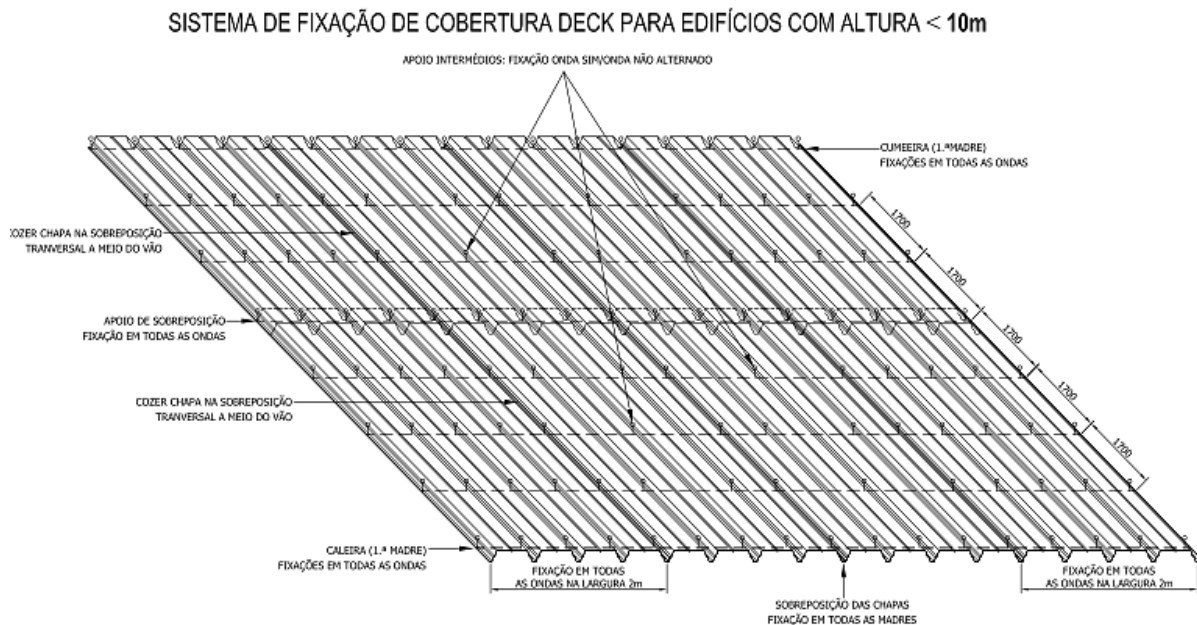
Exemplo do sistema de fixação de cobertura deck aplicado na cobertura
